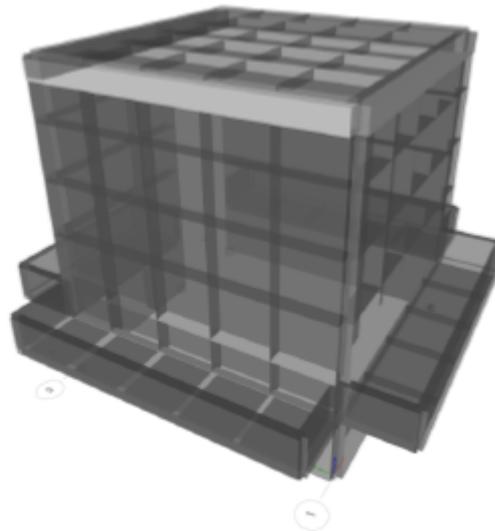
Vista 3D del modelo estructural - lavaderos.
